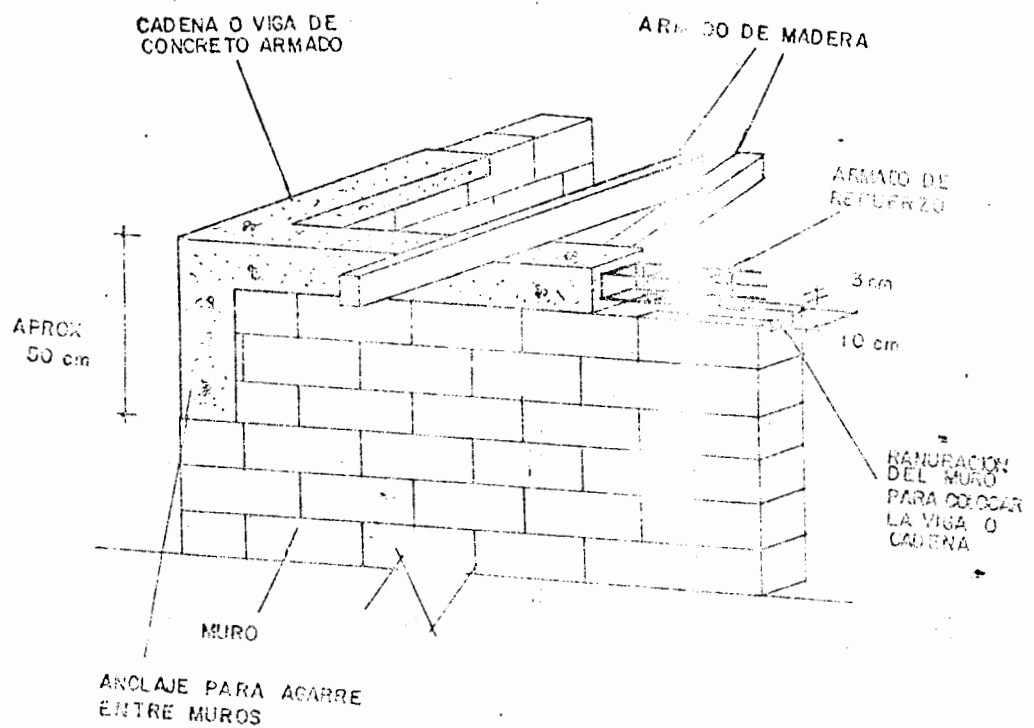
FIG DONDE SE ILUSTR EL CONFINAMIENTO DE UN MURO DE MAMPOSTERIA CON CADENA DE CONCRETO PERIMETRAL
